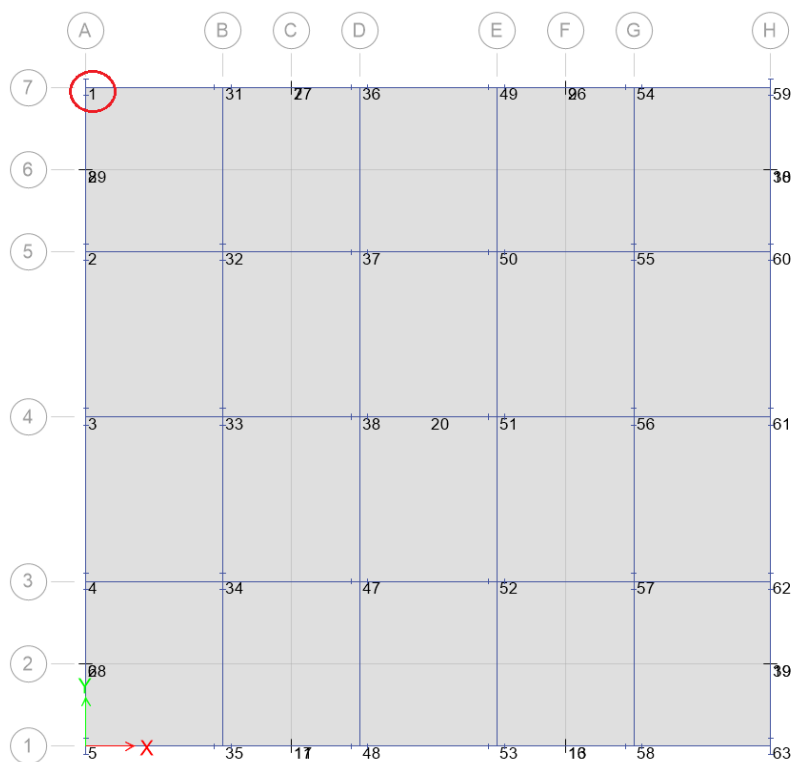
Ubicación del Punto 1, vista en planta del último piso de la estructura.
